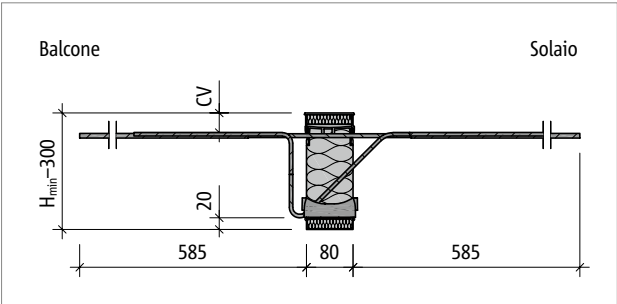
Schöck Isokorb® T tipo KL-M1 – M7-V1/V2: sezione del prodotto
